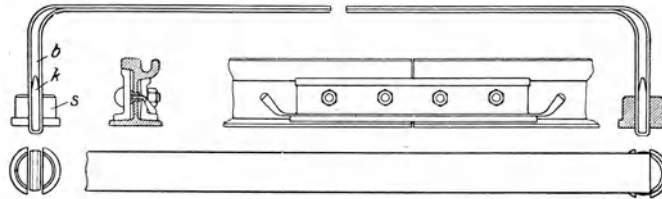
Schienenstoßverbinder mit Keilbefestigung.
